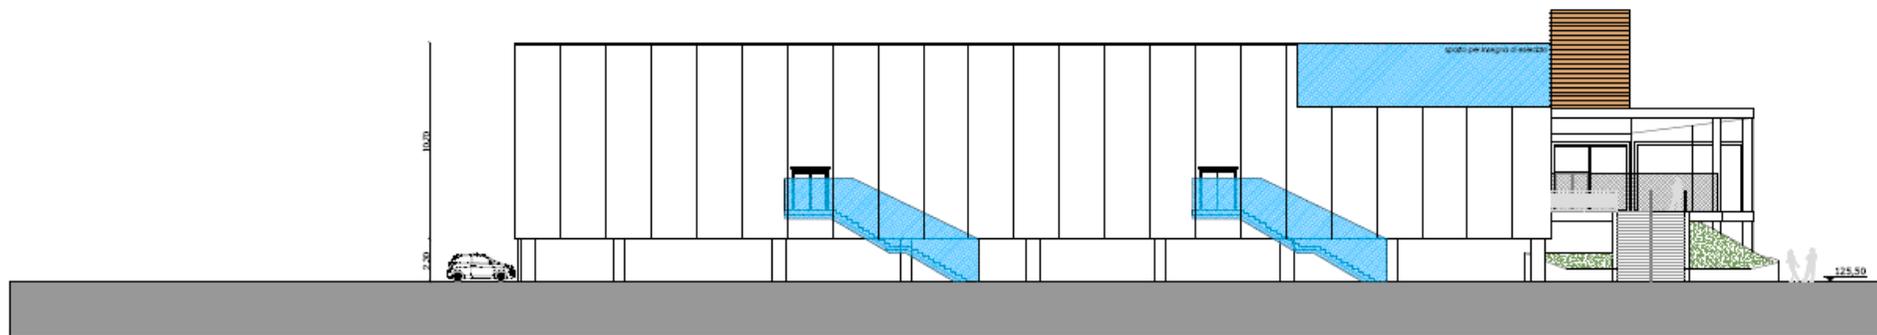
Prospetto Sud (Variante approvata - Tavola 3b)
